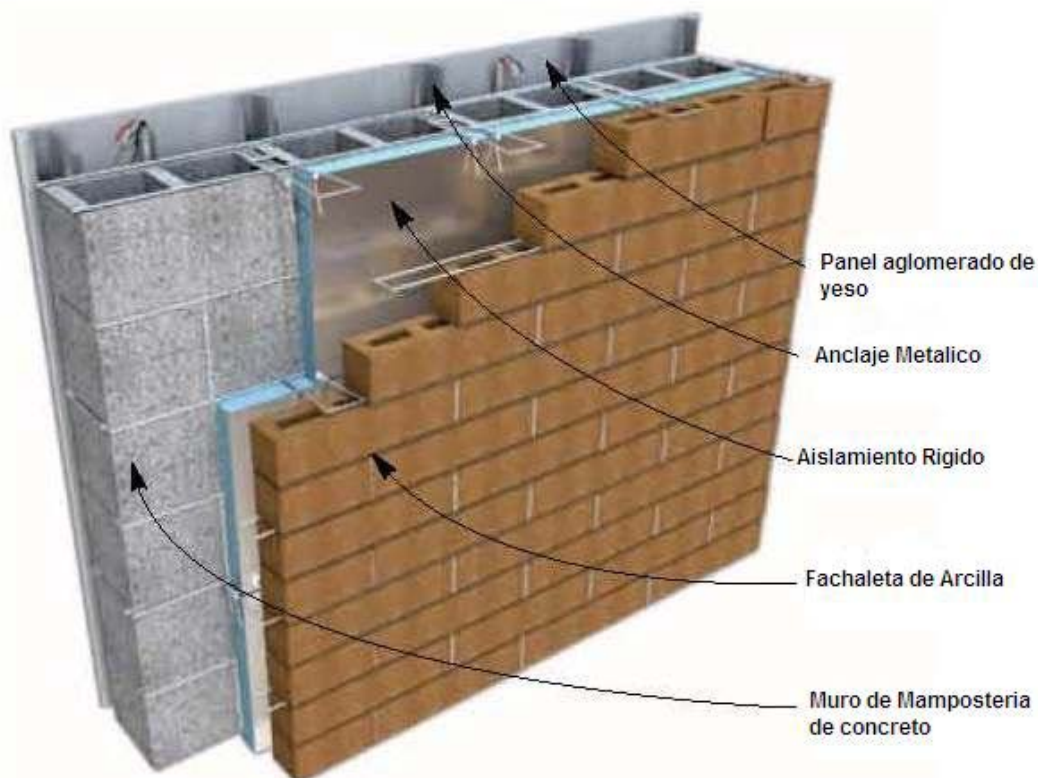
, configuración de blindaje de muro en ambas caras, por medio de paneles de yeso y aislamiento de fibra de vidrio, y levantado de Fachaleta de arcilla, tomado de NCMA, thermal catalog of concrete masonry assamblies
